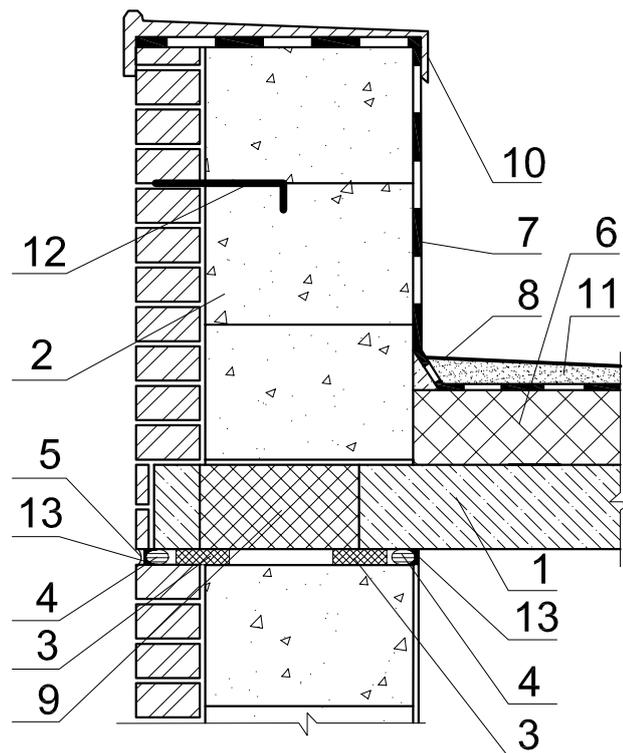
Вариант опирания на стену наклонной крыши из газобетонных плит покрытия ГРАС
